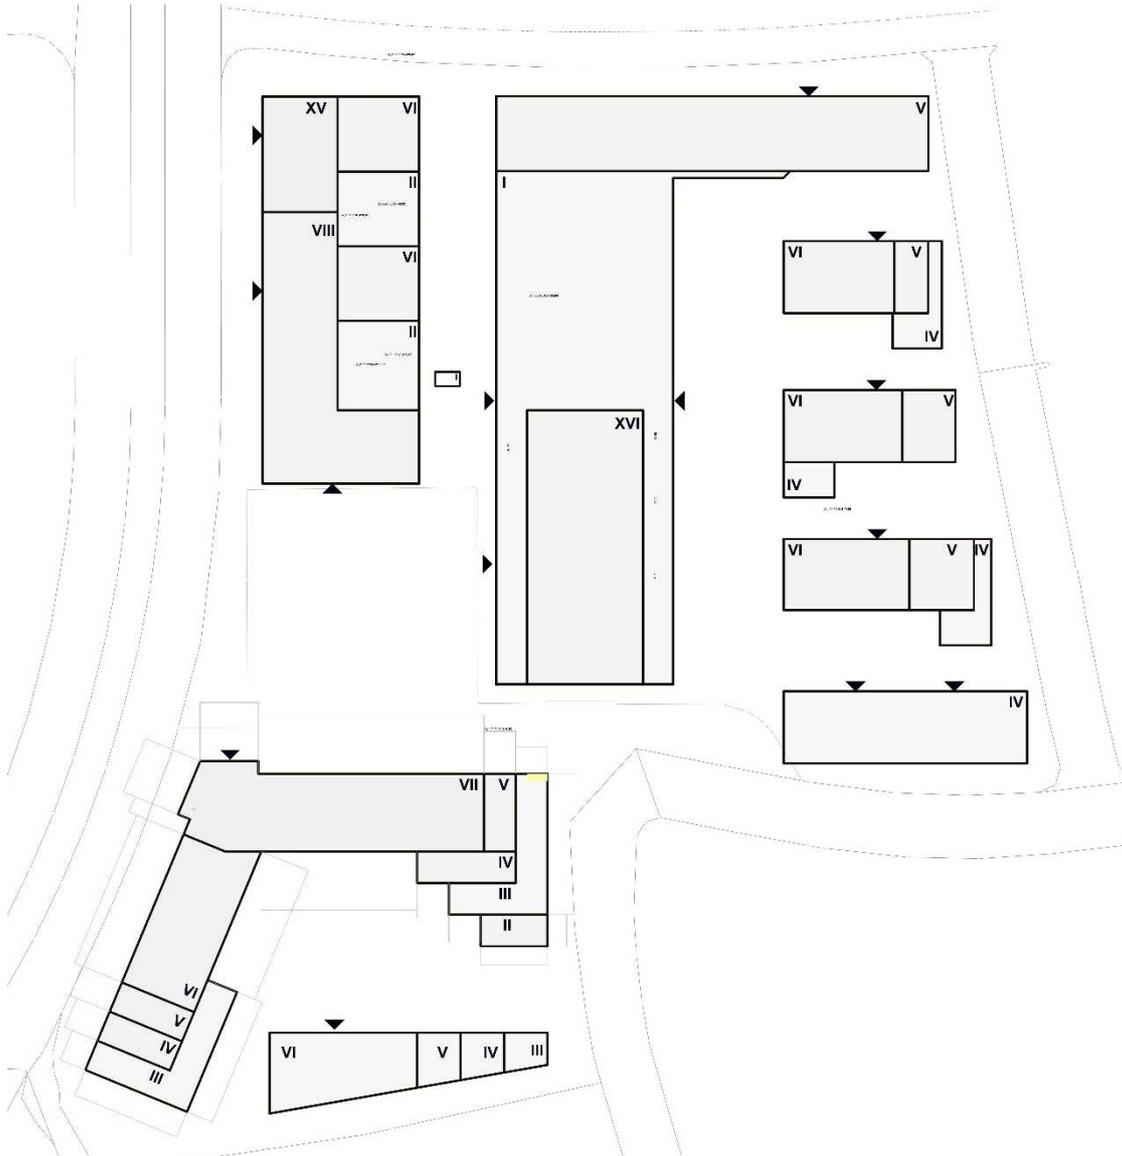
Abstandsflächenplan (ssp-architekten, 28.01.2025)
